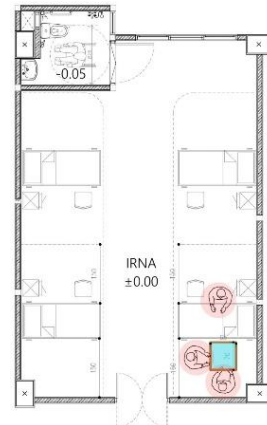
Denah Rekomendasi Ruang Rawat Inap dengan Jarak Lateral
